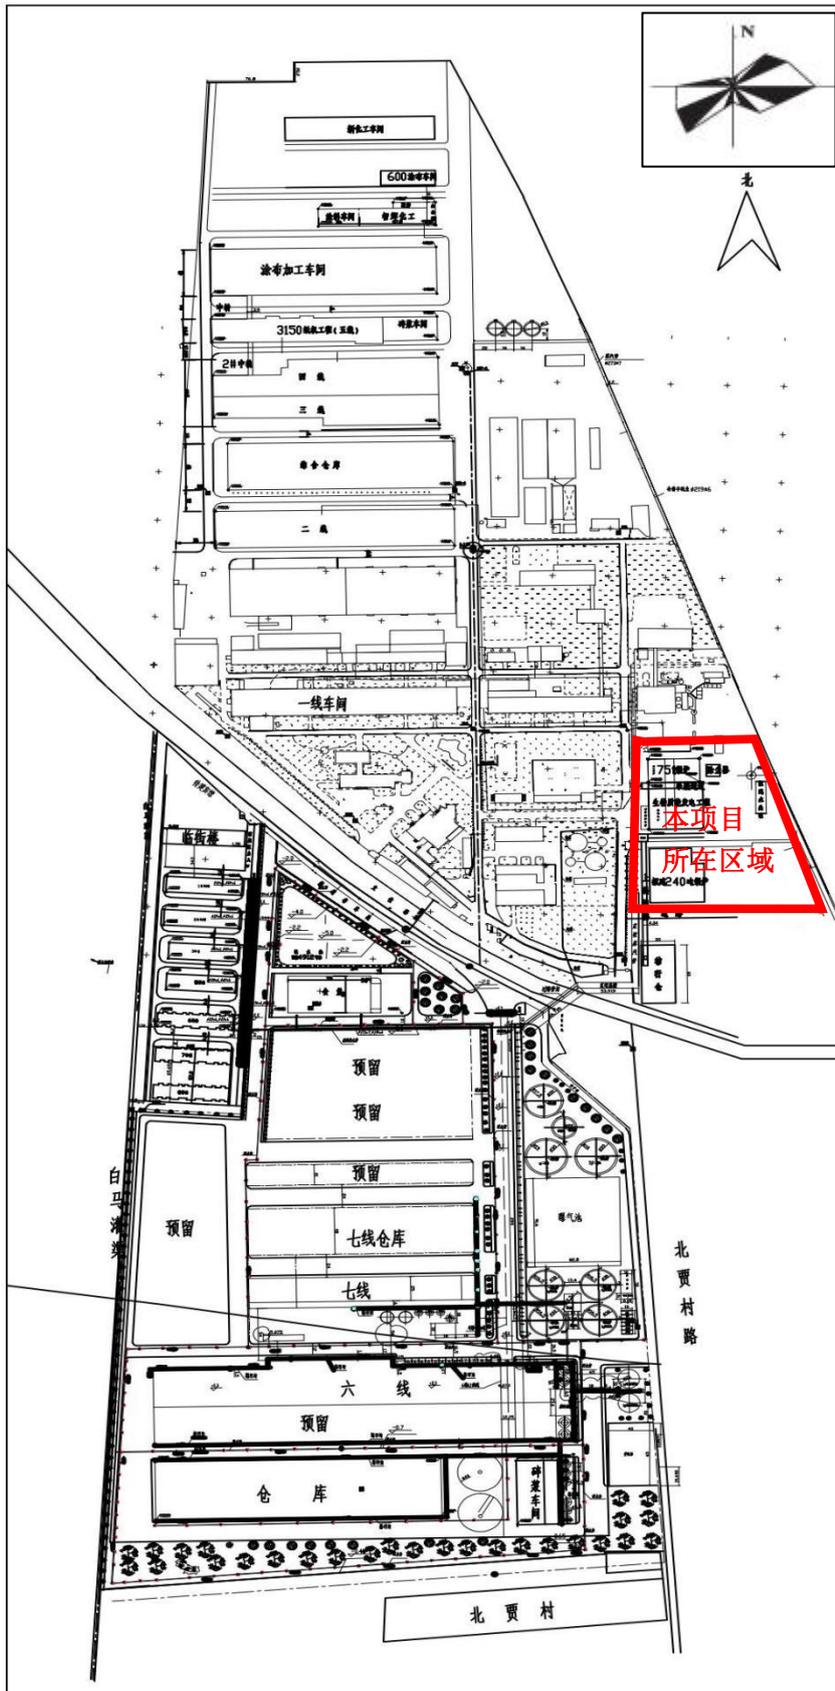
江河纸业厂区平面布置图及本项目位置
